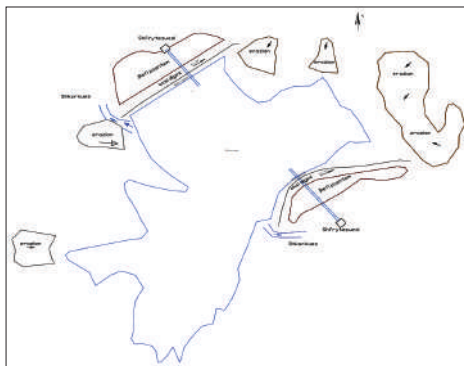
Skica e planimetrisë së digave dhe të rezervuarit Velçan-2
